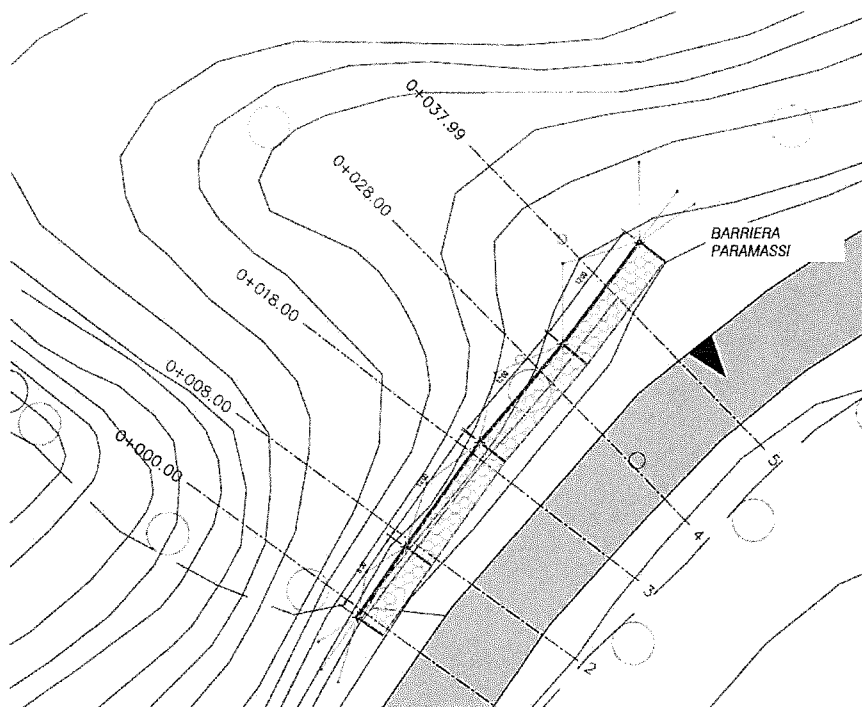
Planimetria con il posizionamento della barriera paramassi indicata in blu (in grigio la S.R.355).
